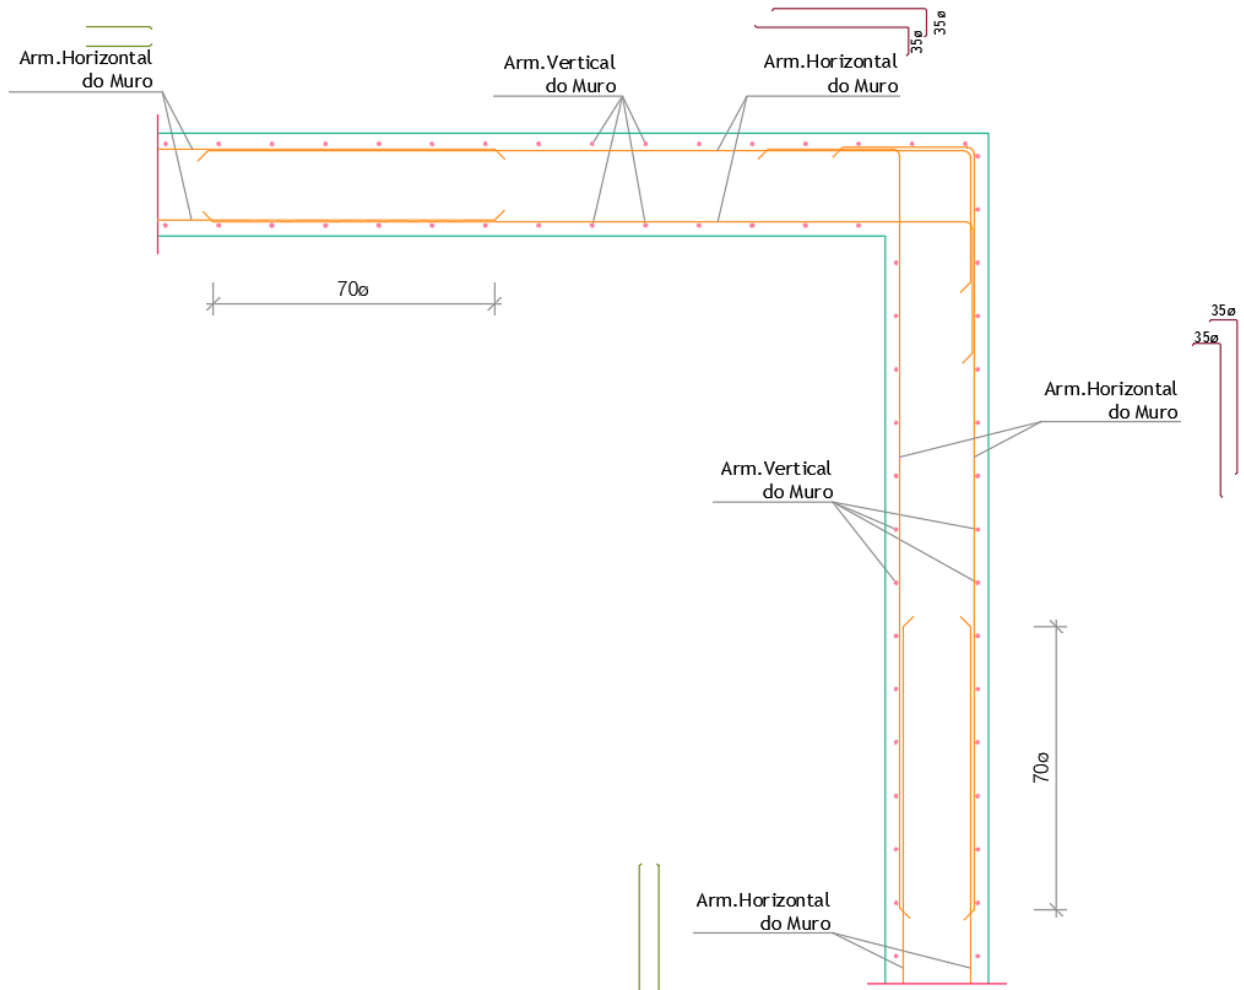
Pormenor de Amarração de Armaduras nos Cantos em Muros (Projeto de estruturas).
